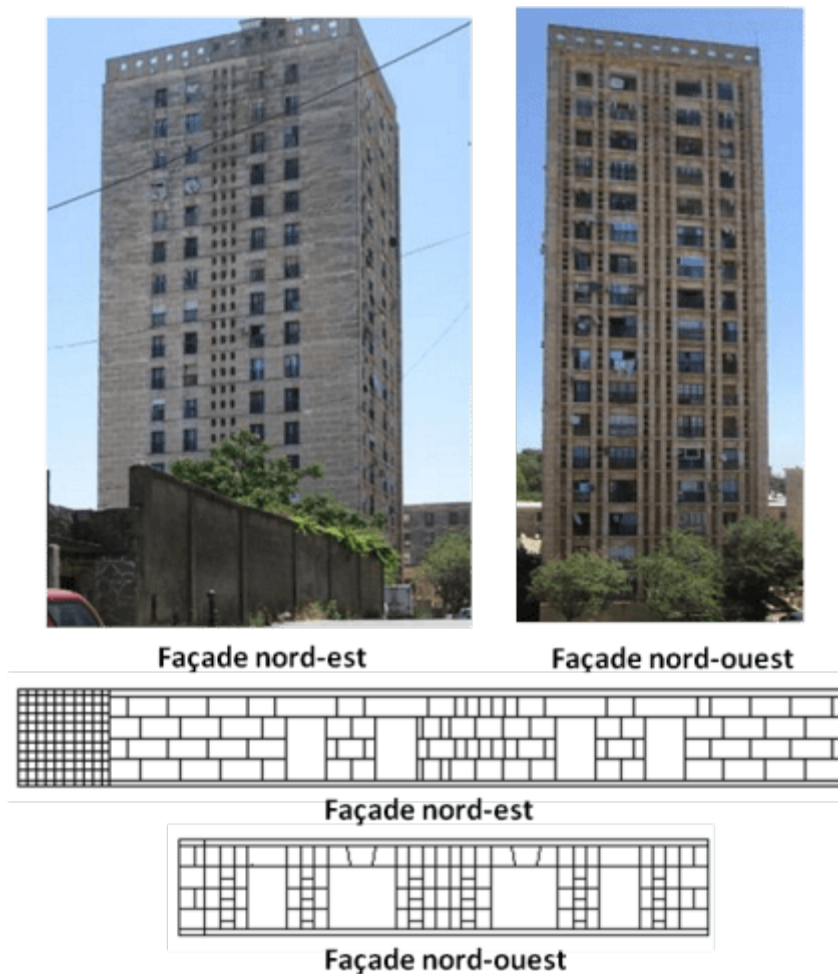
11: Les façades de la tour et l'appareillage de pierre pour un niveau.
